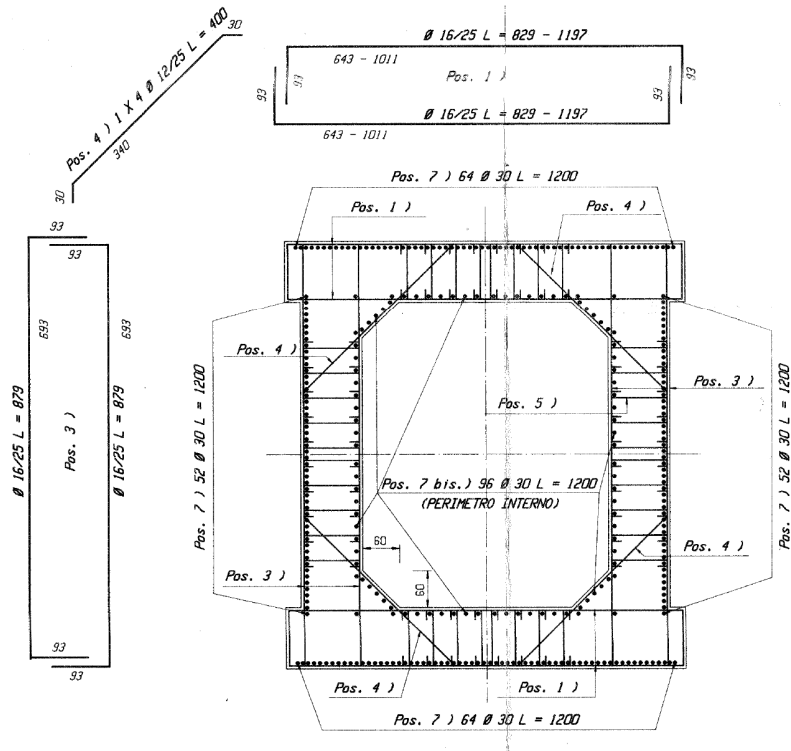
Sezione allo spiccatto delle pile P2, P3
